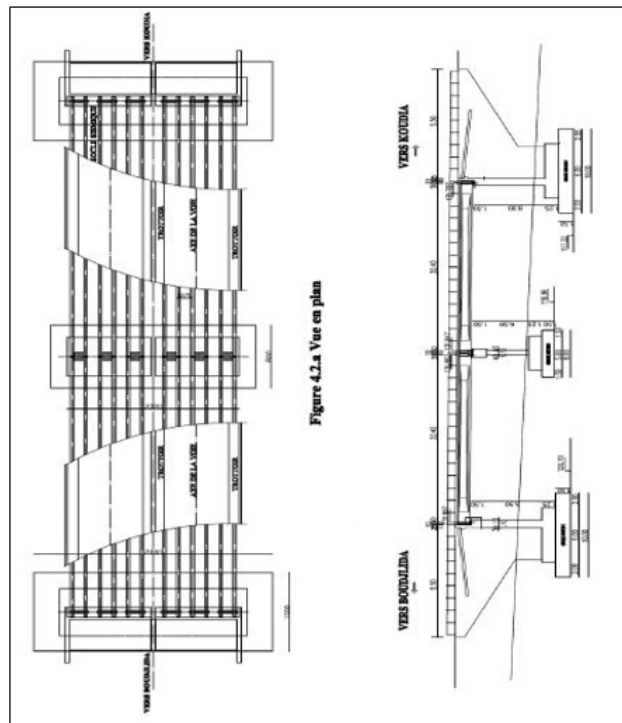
a)Vue en plan, b)Vue en élévation
